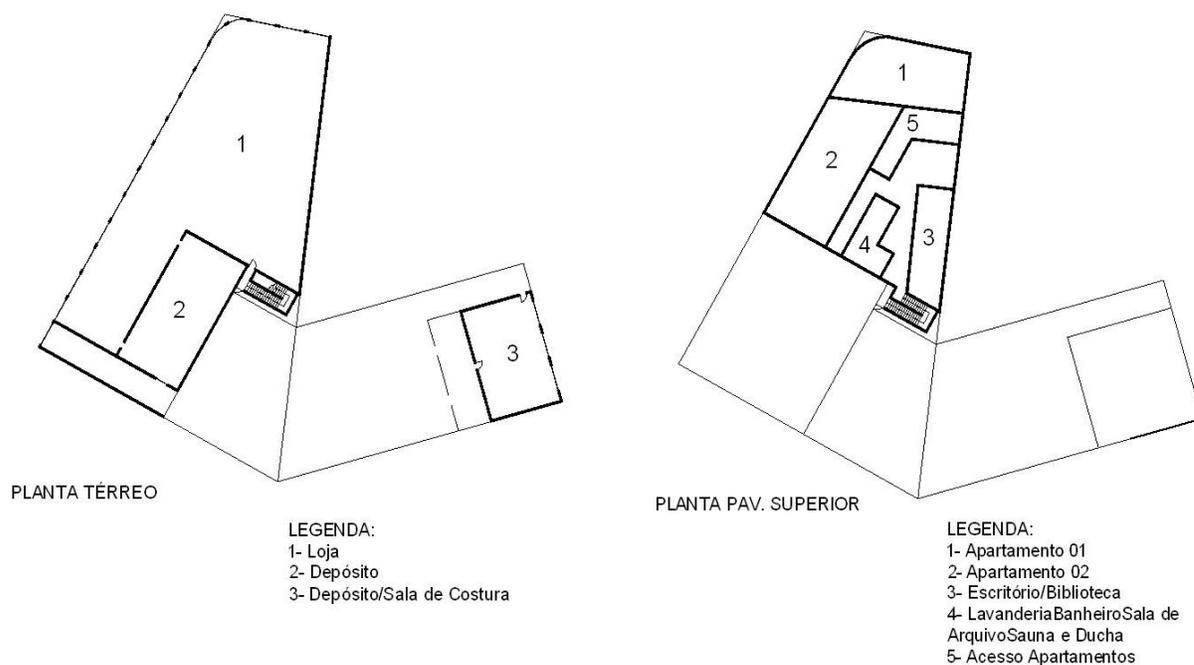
PLANTAS ESQUEMÁTICAS DAS TRÊS CONSTRUÇÕES.
